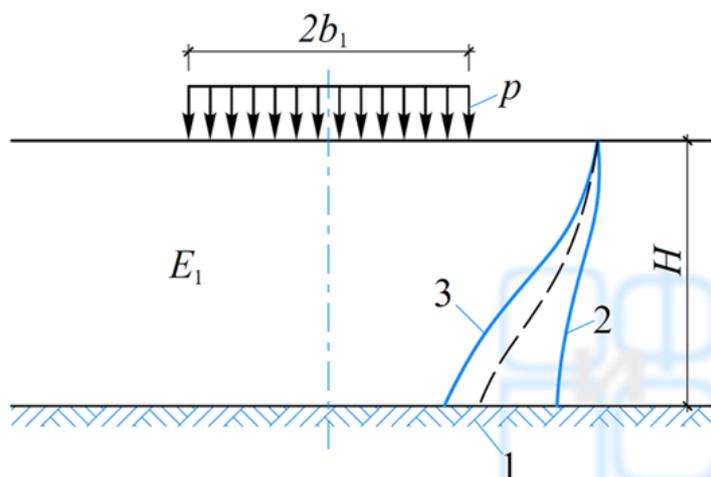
Схема распределения вертикальных нормальных напряжений в основании под центром равномерно загруженной, прямоугольной площадки
